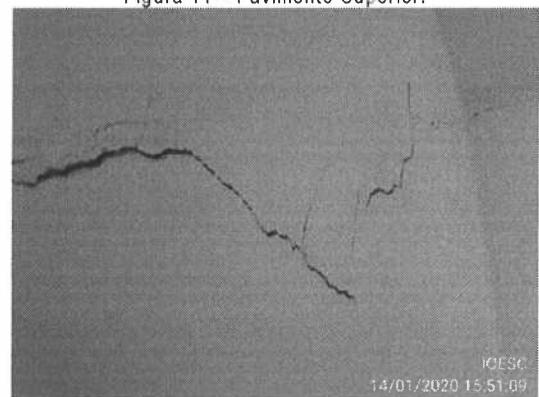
Pavimento Superior – Sala com trinca em alvenaria.
